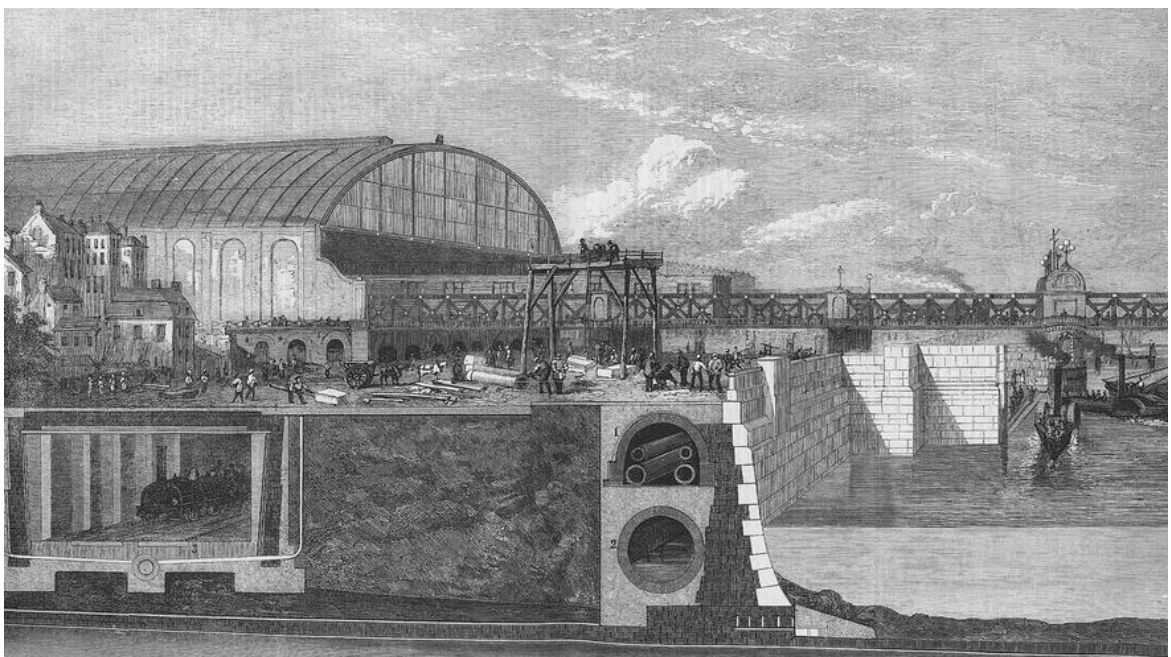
| Sección transversal de parte del sistema de alcantarillado de Londres.
